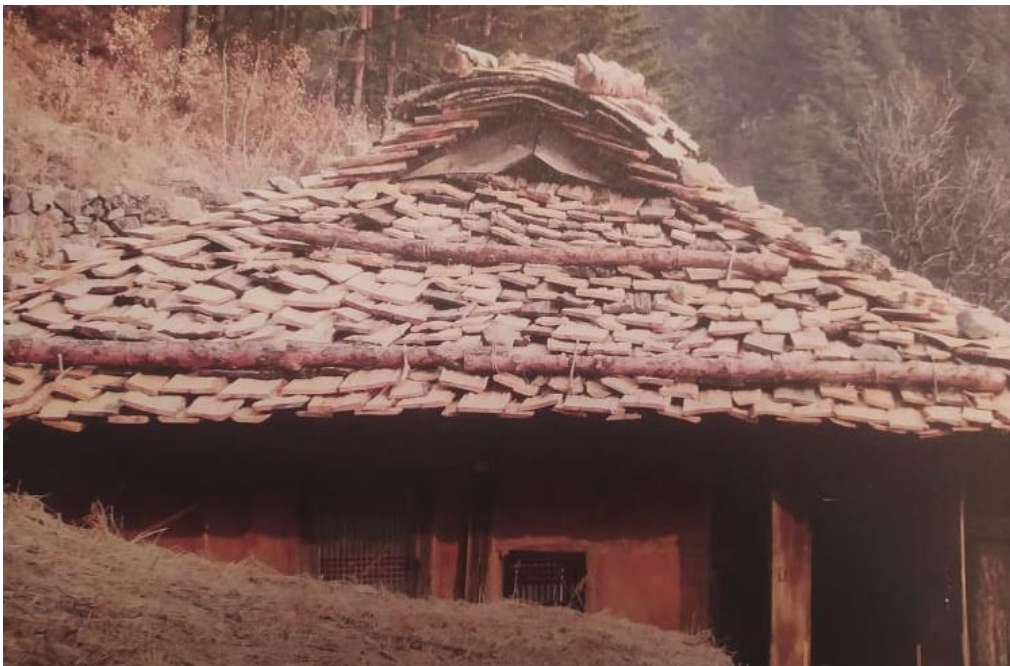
Telhado de uma casa *Neowa*, construído em telhas de madeira (Piesik 2017, p. 351).
